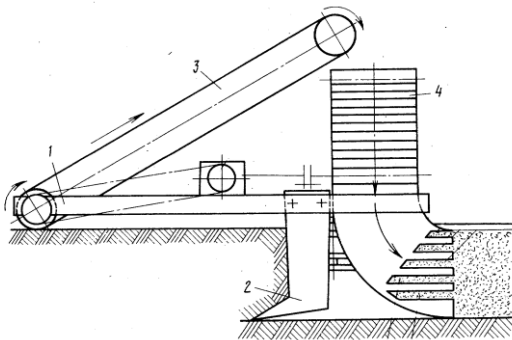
Однооперационный агрегат заполняющий щель ротором: 1 – рама; 2 – щелерез; 3 – ротор; 4 – привод ротора; 5 – кожух
